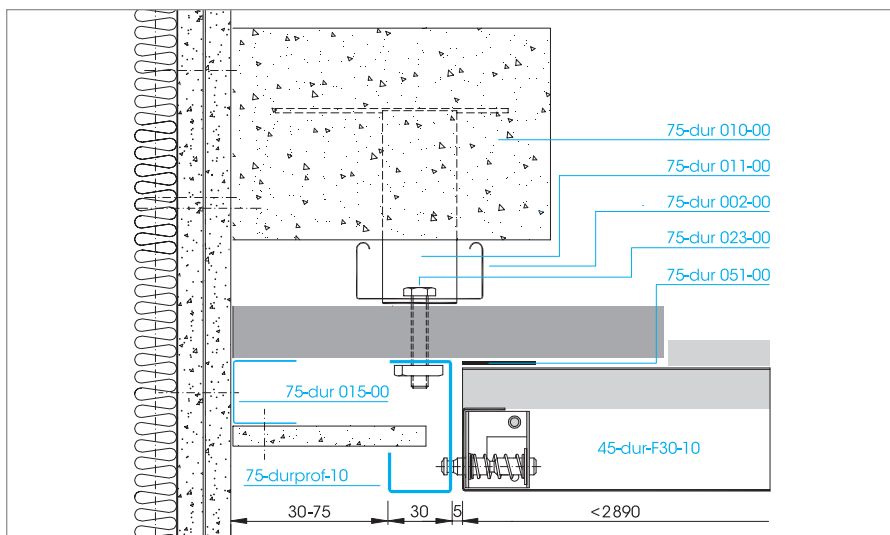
Baudehnungsfuge – Ansicht an Wandanschluss
